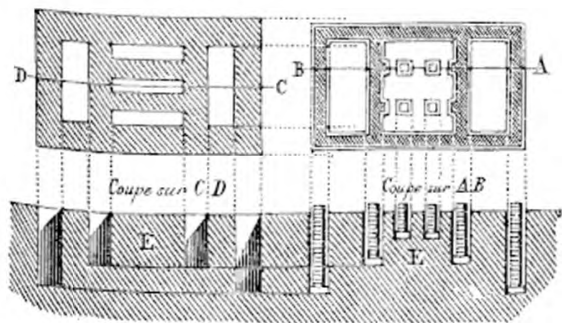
, 41, 42 et 43. Plan du mur en fondation d'un bâtiment.
